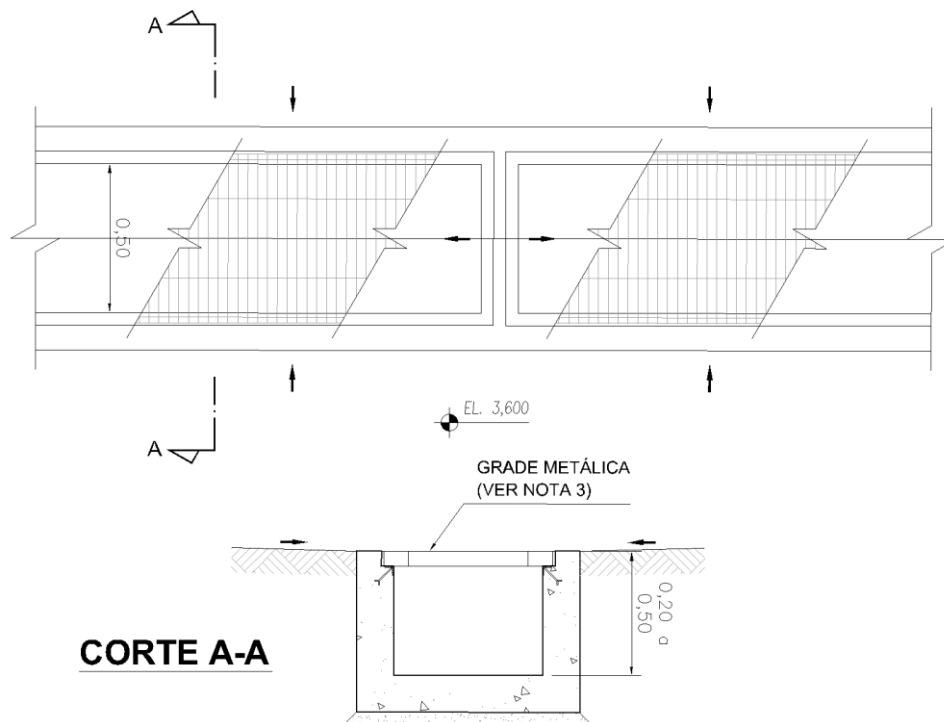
Canaleta de concreto armado com grelha metálica. Fonte: Software AutoCAD
